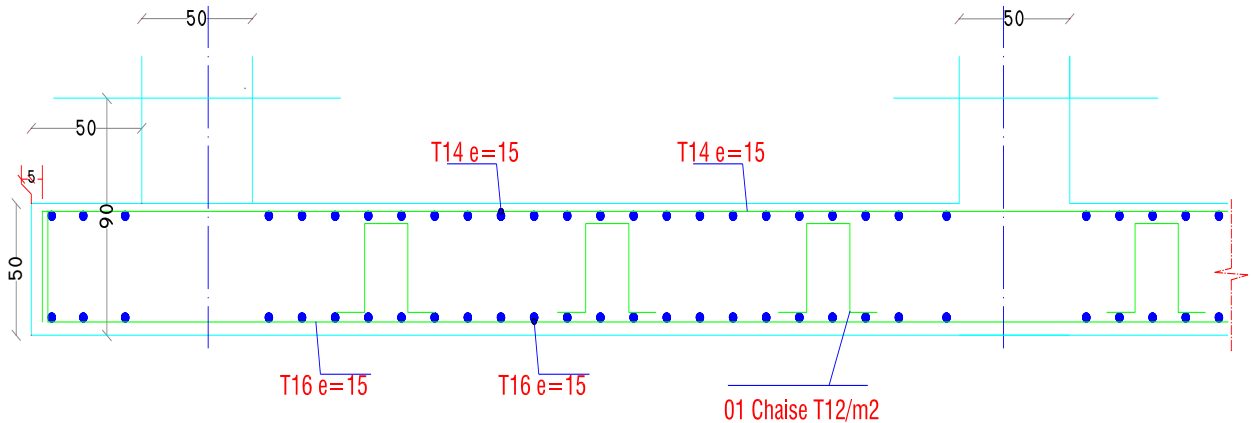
Exemple de coupe de ferrailage de la dalle de radier général
